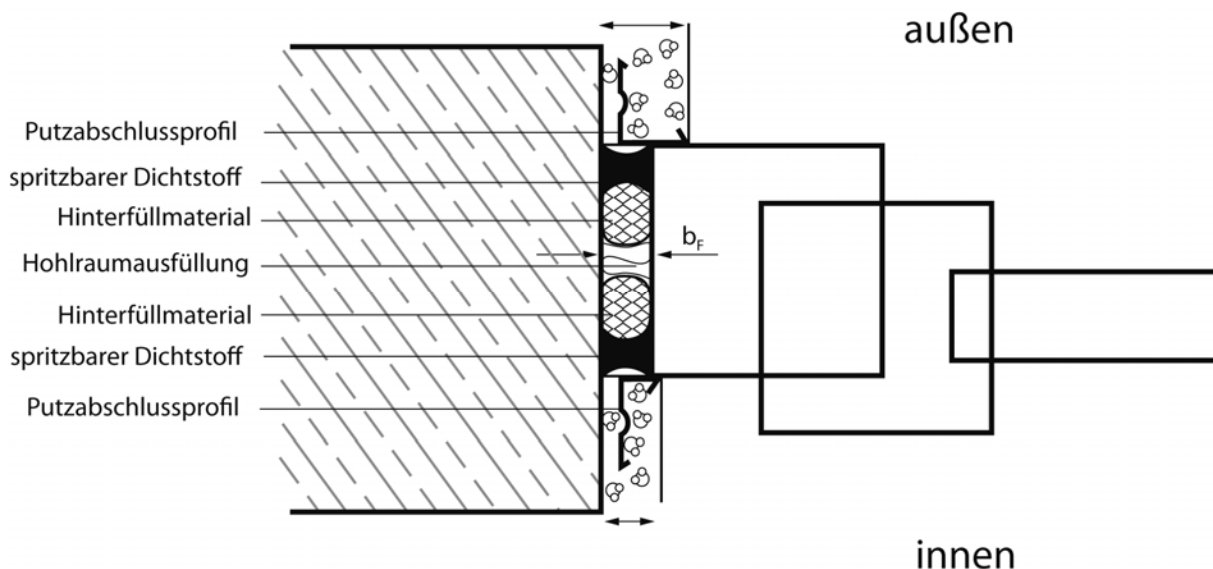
Fachgerechte Fugenabdichtung vor dem Verputzen des Baukörpers
